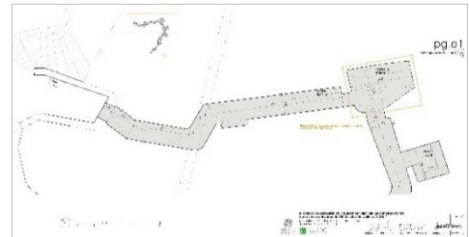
Planta de la galería. (Sender, Giménez, Perelló, Rodríguez & Gil, 2023).
